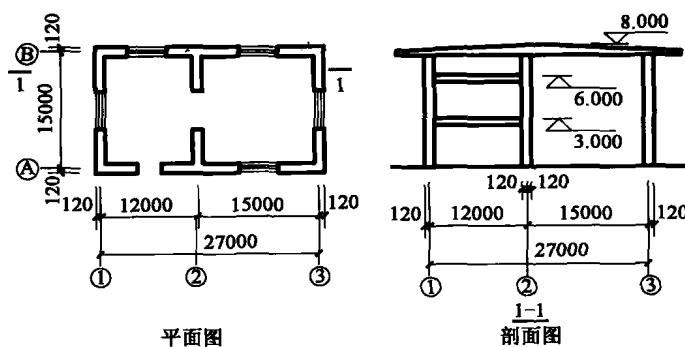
单层厂房平面及剖面图(尺寸单位:mm)
